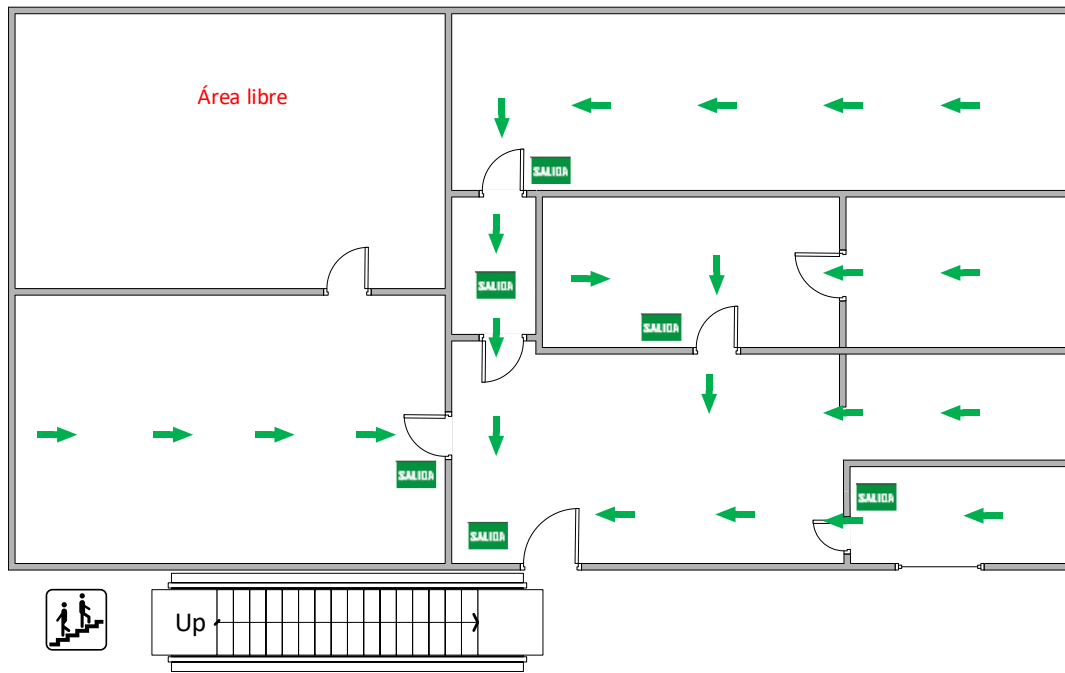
Mapa de Evacuación- Primera planta ferretería
